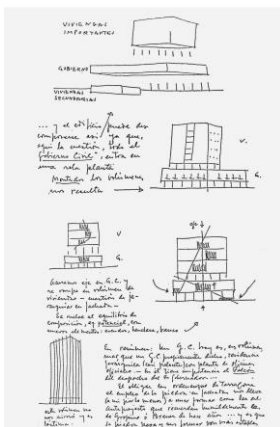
e 2. Schizzi esplicativi del processo concettuale del progetto e planimetria
